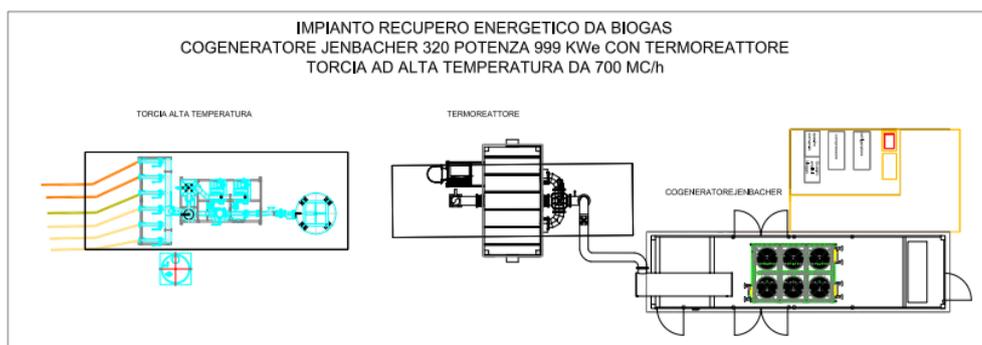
stralcio grafico tratto da elaborato TAV 6.01 Planimetria generale impianto di recupero biogas
